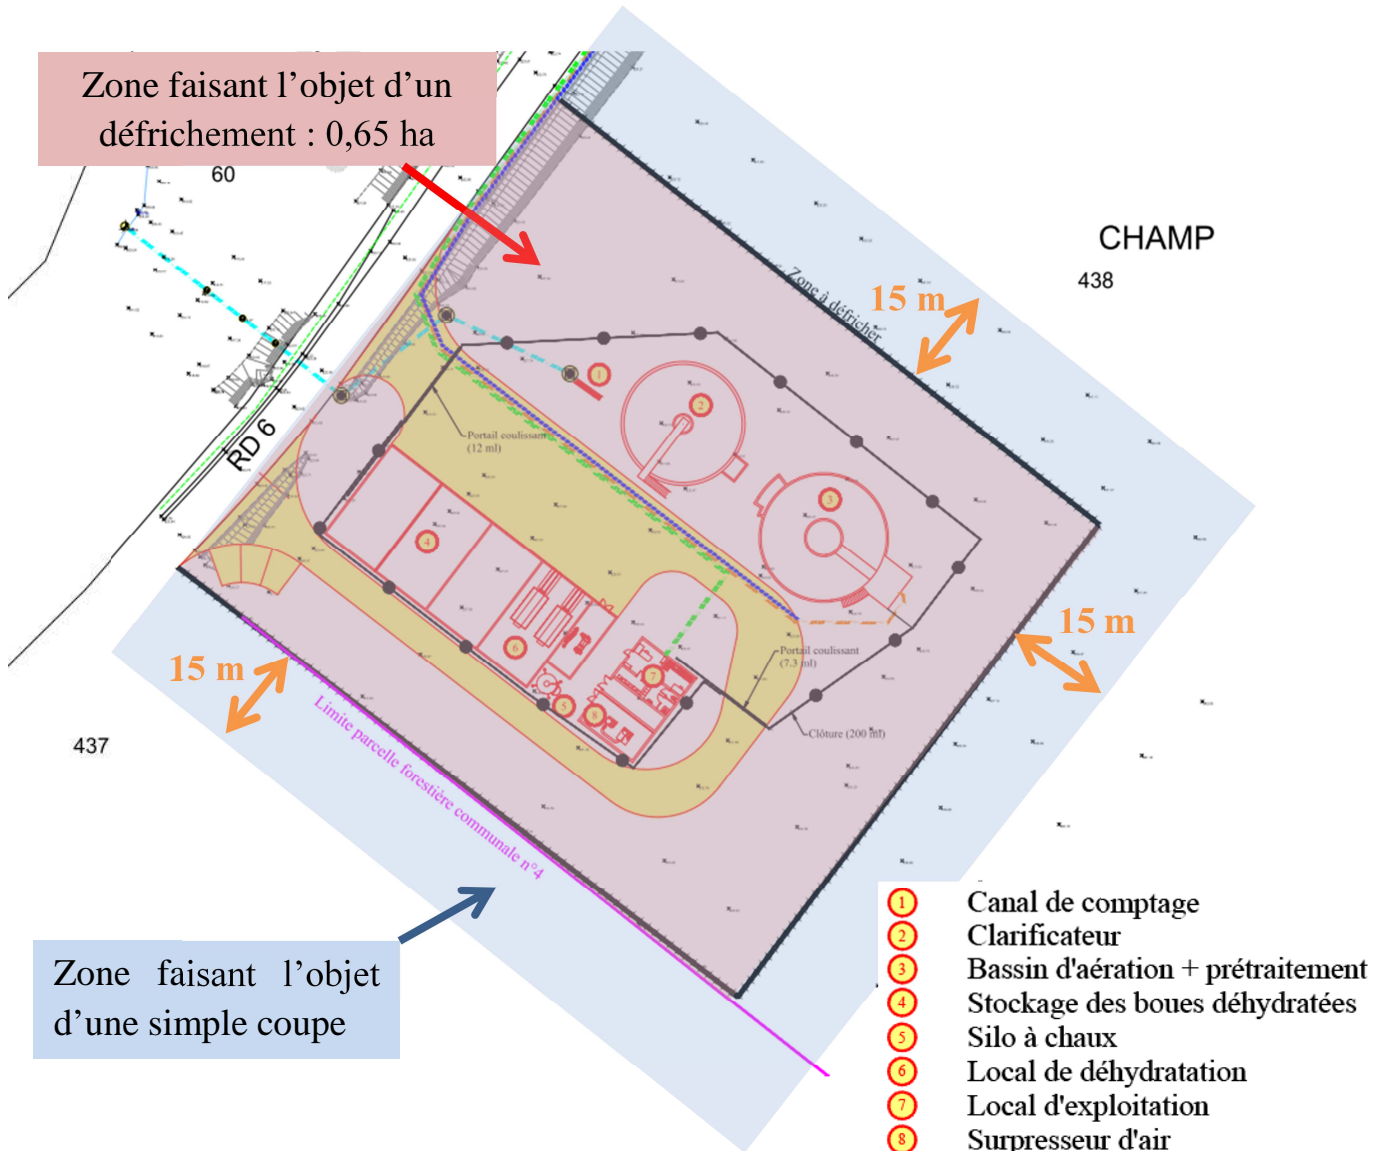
implantation pressentie des ouvrages de la future station de traitement sur le site d'étude
